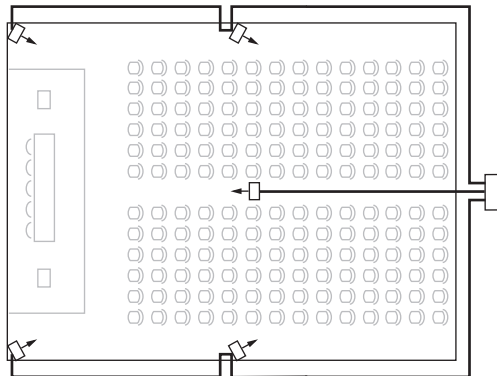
Cablagem de radiador simétrica (recomendada)
